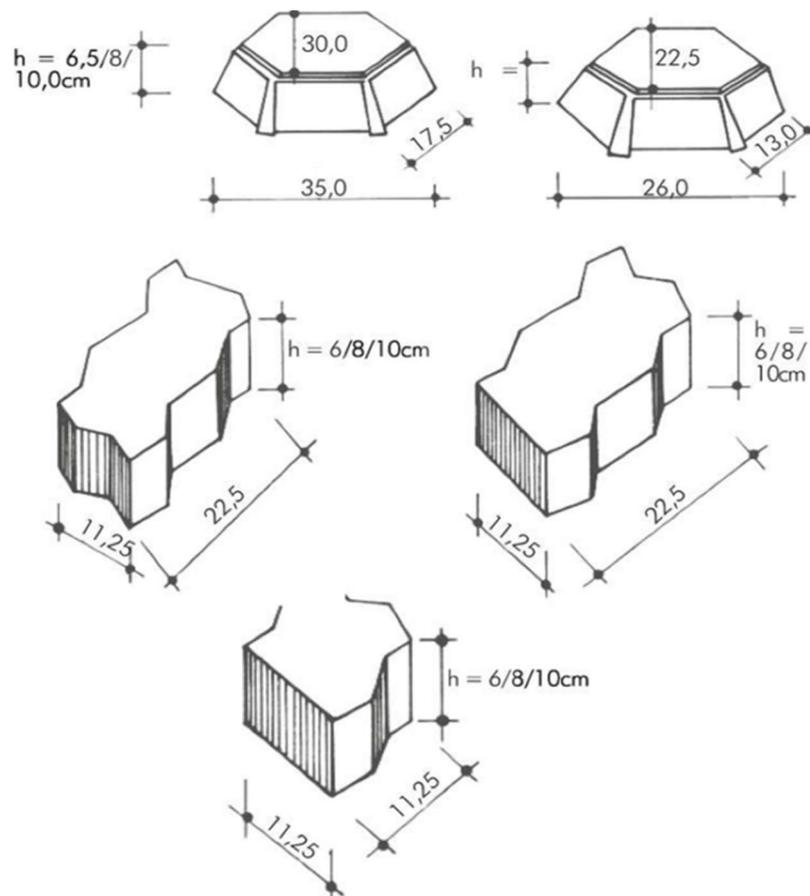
Tipos alternativos de blocos articulados de concreto.
